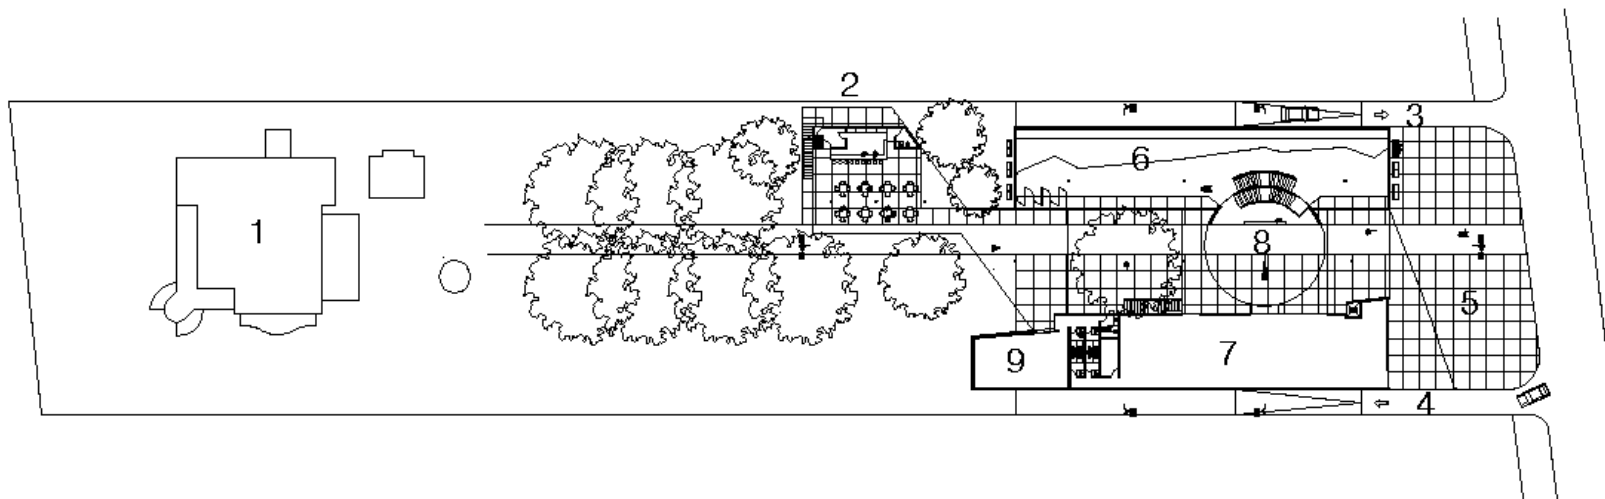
Proposta de intervenção – pavimento térreo do prédio novo
